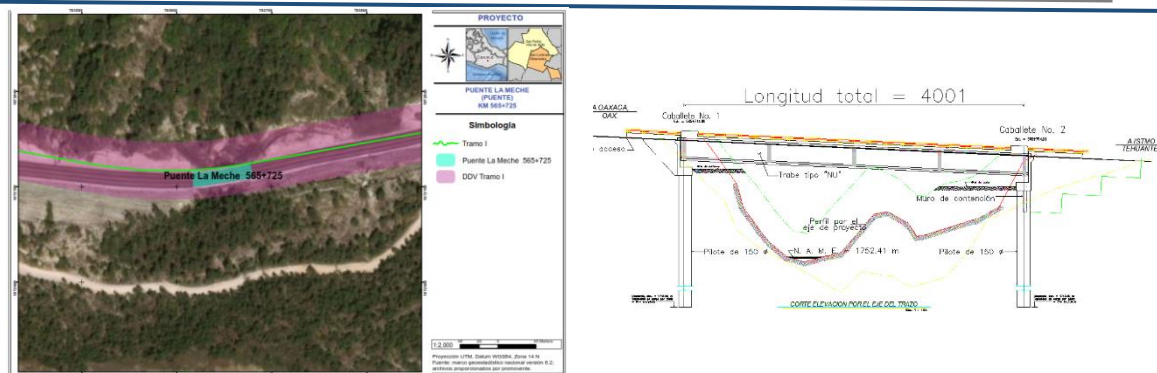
Proyecto en planta y perfil longitudinal del Puente la Meche 565+725.
